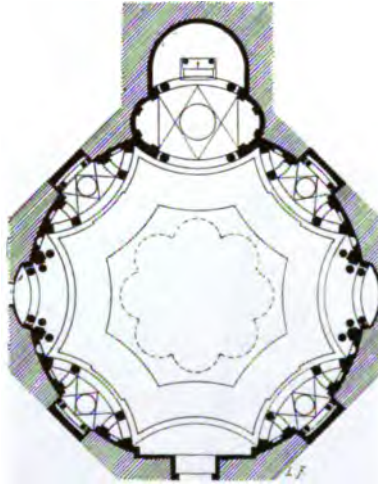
Grundriss von S. Lorenzo zu Turin
